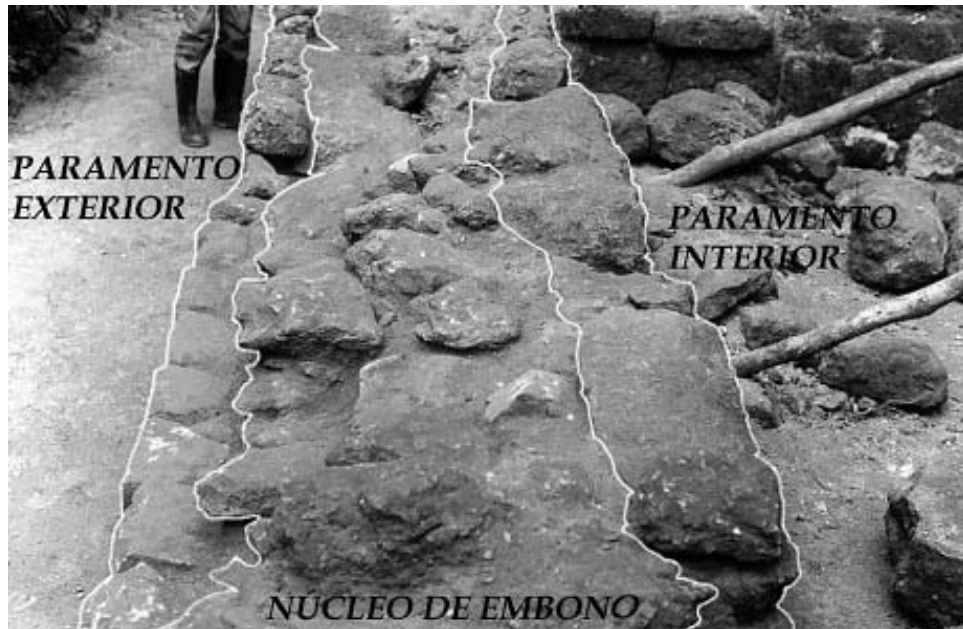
Componentes de un muro de mampostería maya, estructura 6F - 9 del Grupo Guacamaya.
